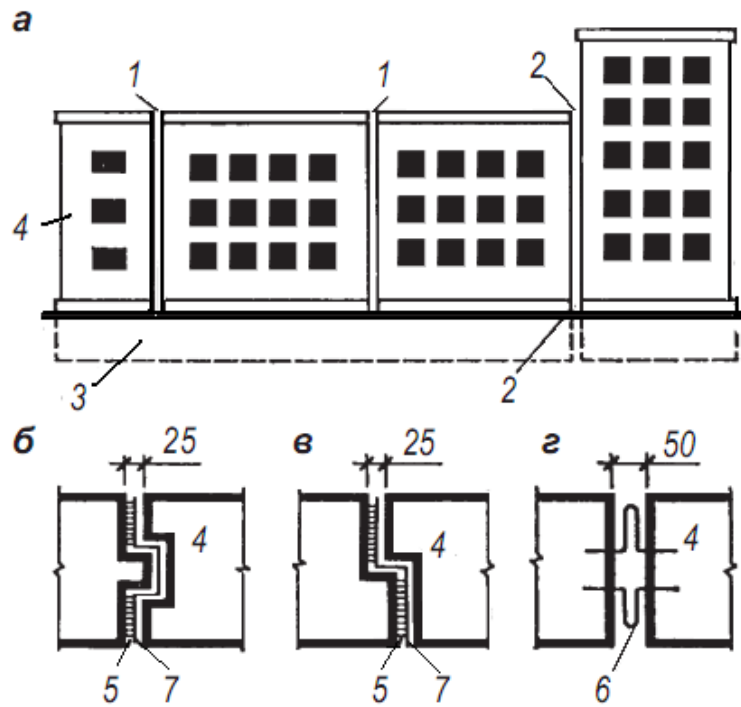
Схеми розташування і конструкцій деформаційних швів: а – фасад будівлі; б – температурний і осадові шви з пазом і гребенем; в – теж, в чверть; г – температурний шов з компенсатором; 1 – температурний шов; 2 – осадовий шов; 3 – фундамент; 4 – стіна; 5 – утеплювач; 6 – компенсатор; 7 – рулонна ізоляція
